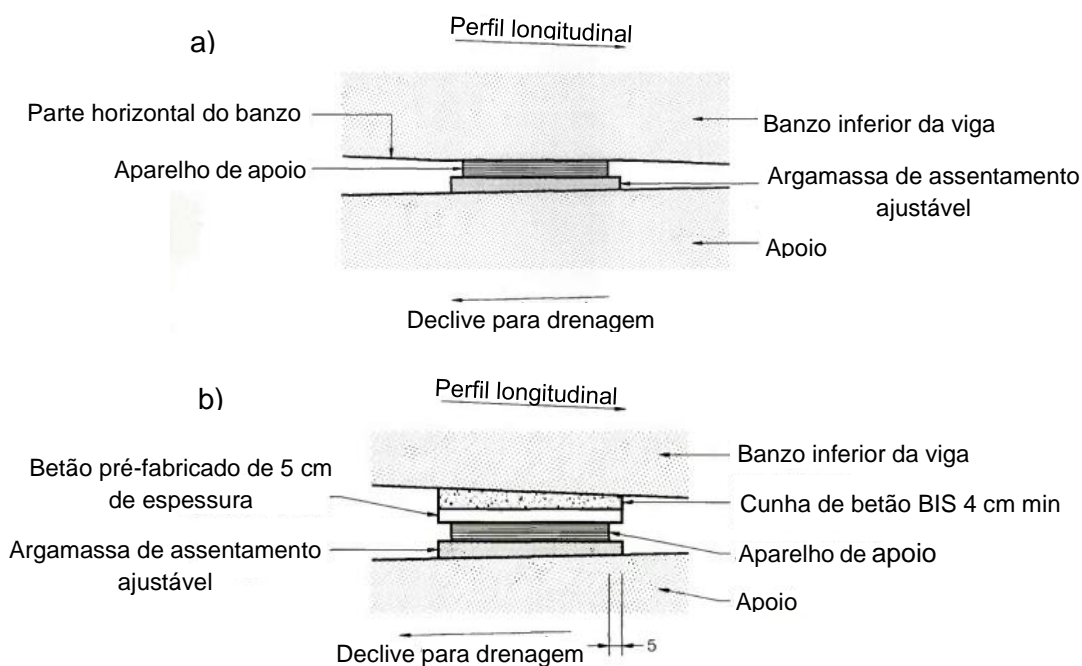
Disposições do aparelho de apoio para aplicação do declive longitudinal na viga. a) Adopção de uma superfície horizontal na viga b) Uso de argamassa BIS para a disposição da inclinação. Fonte: Adaptado de SETRA 1996.
